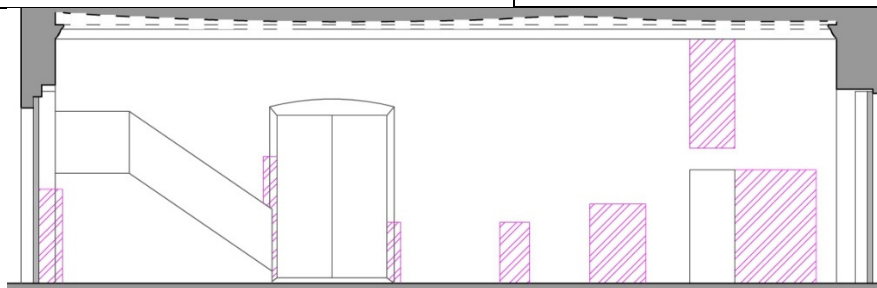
Detalle pintura desconchada. Alzado-sección Sala Capitular
